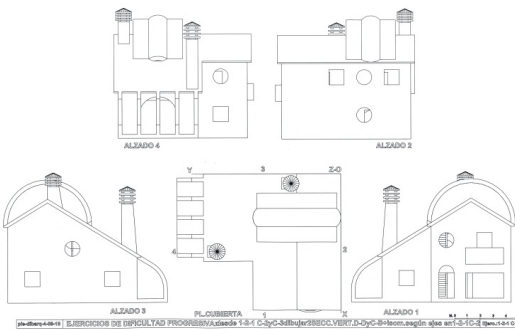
Ej. 2-1-1 C-2 Alzados+pl.cubierta 2011 Moodle/OCW
